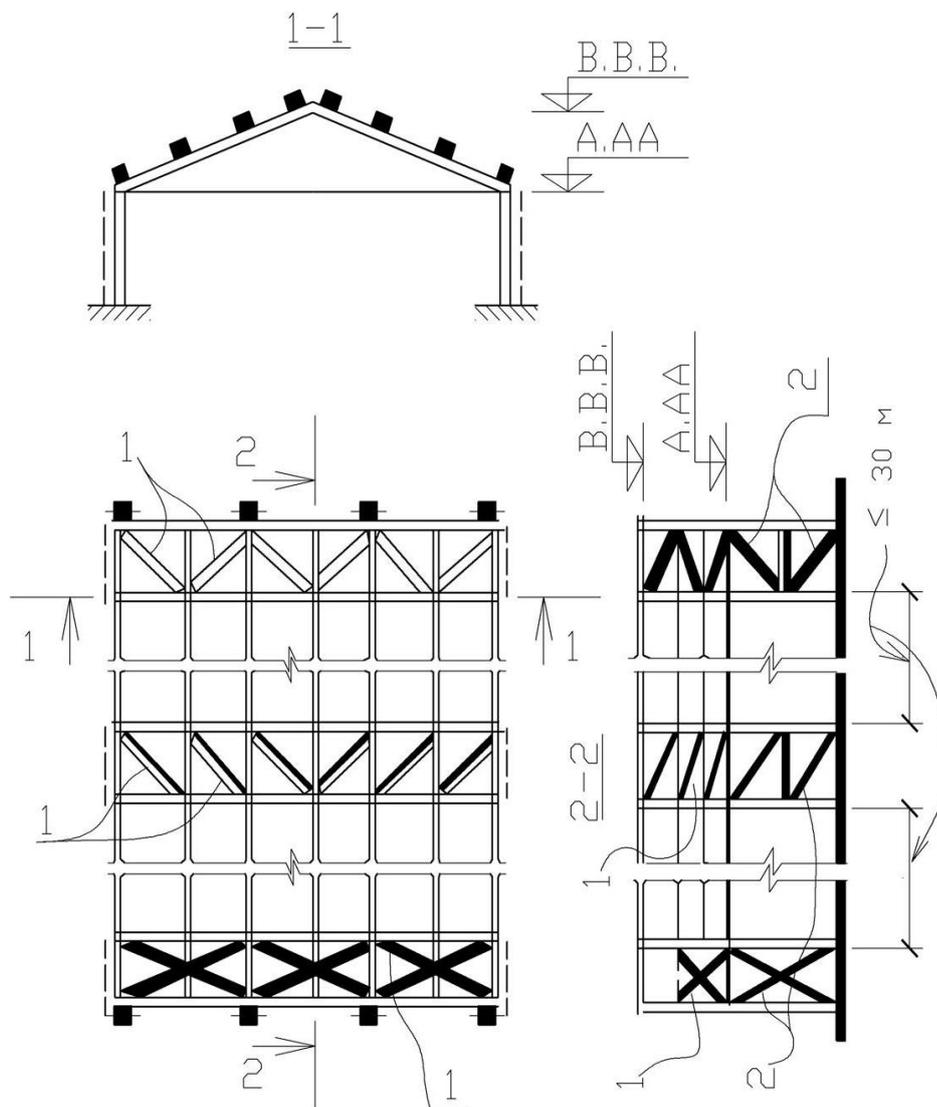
Схема каркаса здания со стойками и ригелем: 1 – горизонтальные связи в покрытии; 2 – вертикальные связи по колоннам
